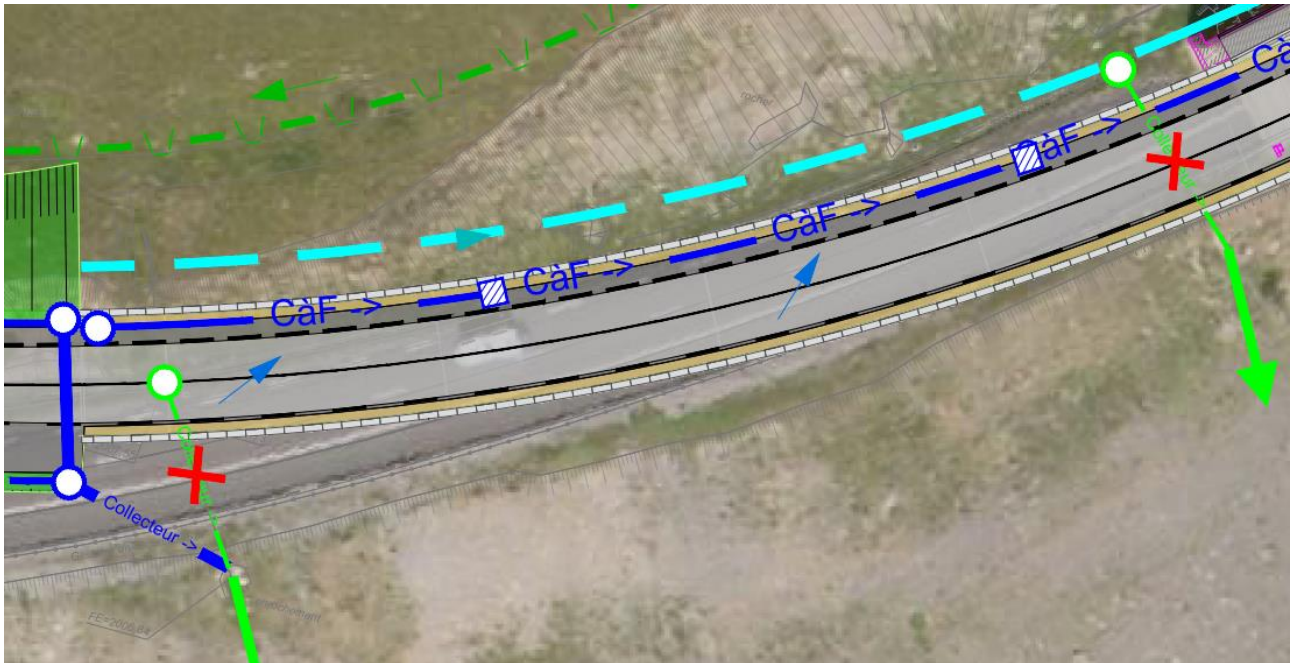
Extrait du plan d'assainissement lors de la construction d'un nouveau mur amont
